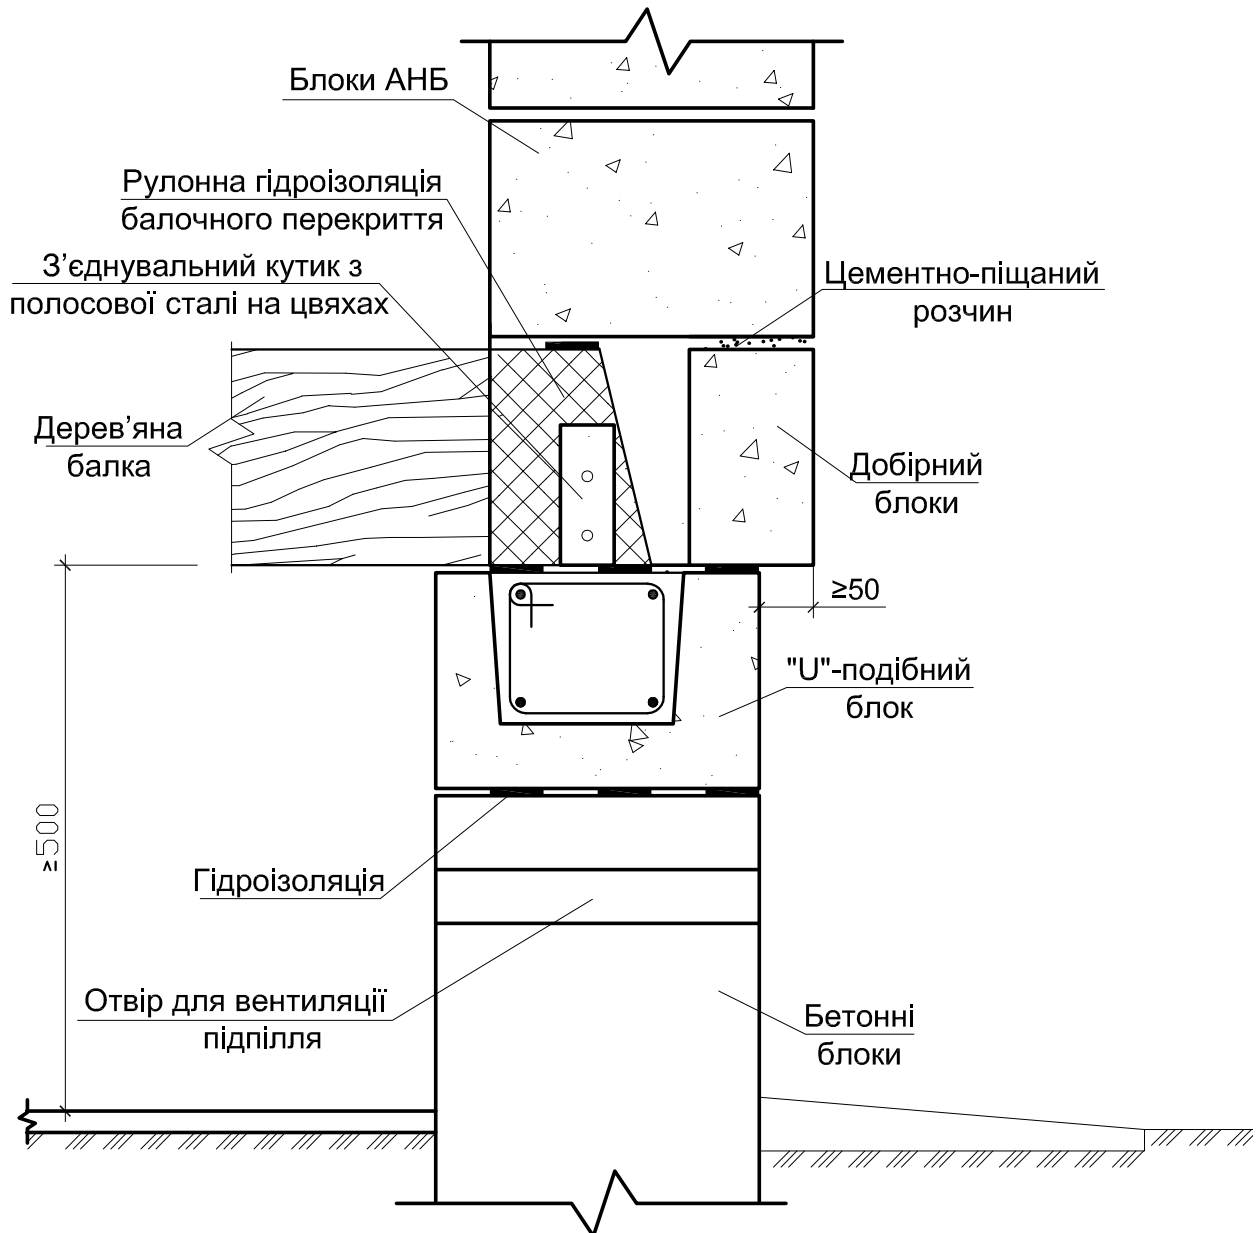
2-7. Спирання дерев'яного балочного перекриття на фундамент зовнішньої стіни
